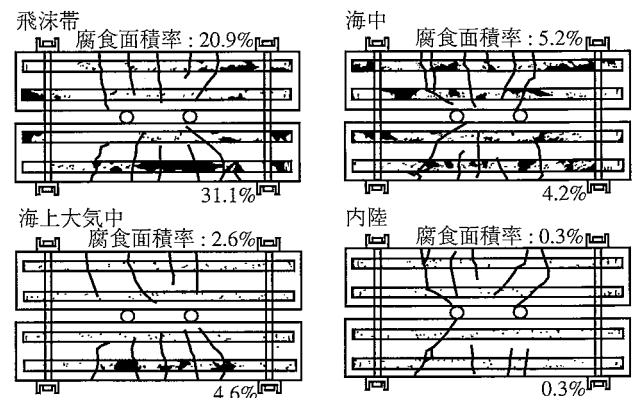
ひび割れのある場合の鉄筋の腐食状況
